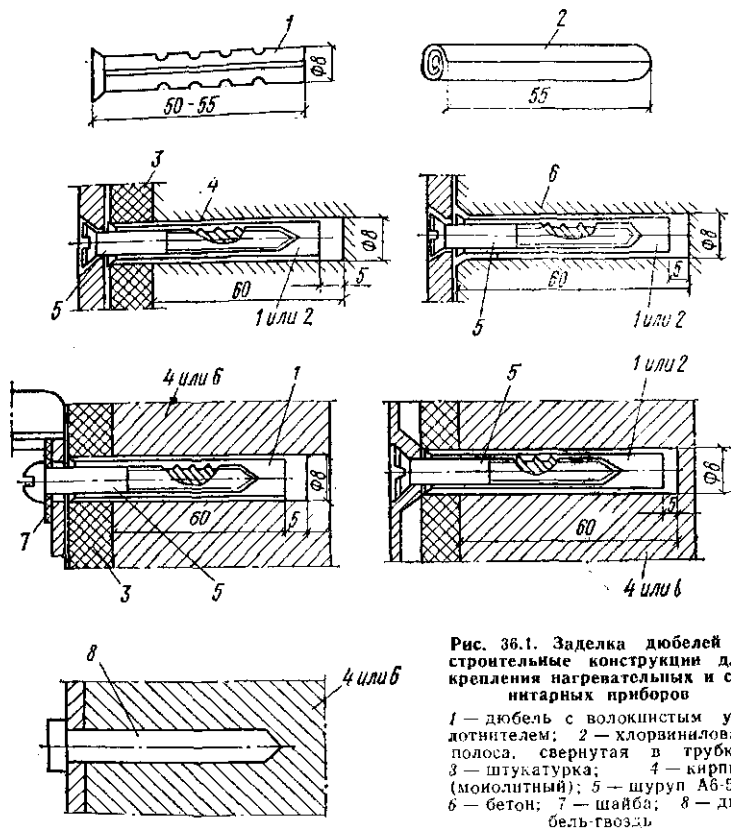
Заделка дюбелей в строительные конструкции для крепления нагревательных и санитарных приборов
